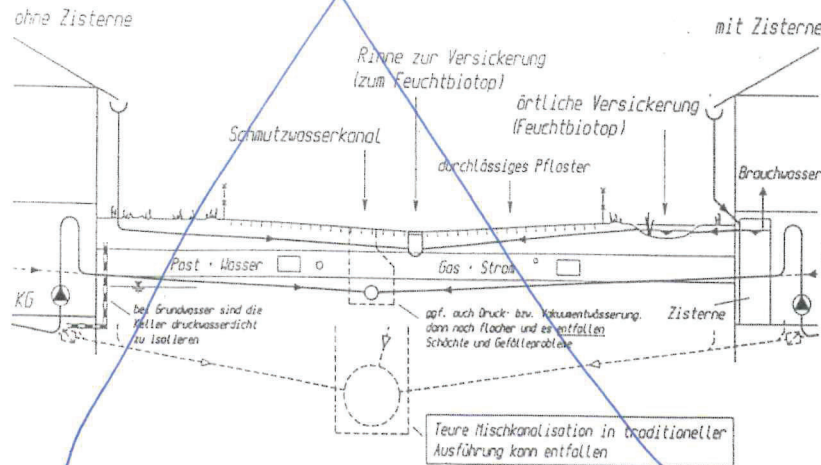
Straßenquerschnitt bei einem modifizierten Entwässerungsverfahren
